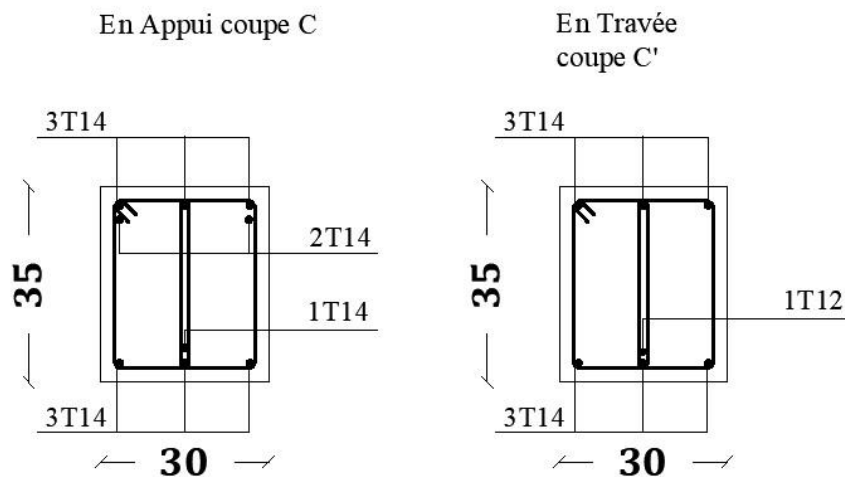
Croquis de ferrailage de la poutre principale 30x35
